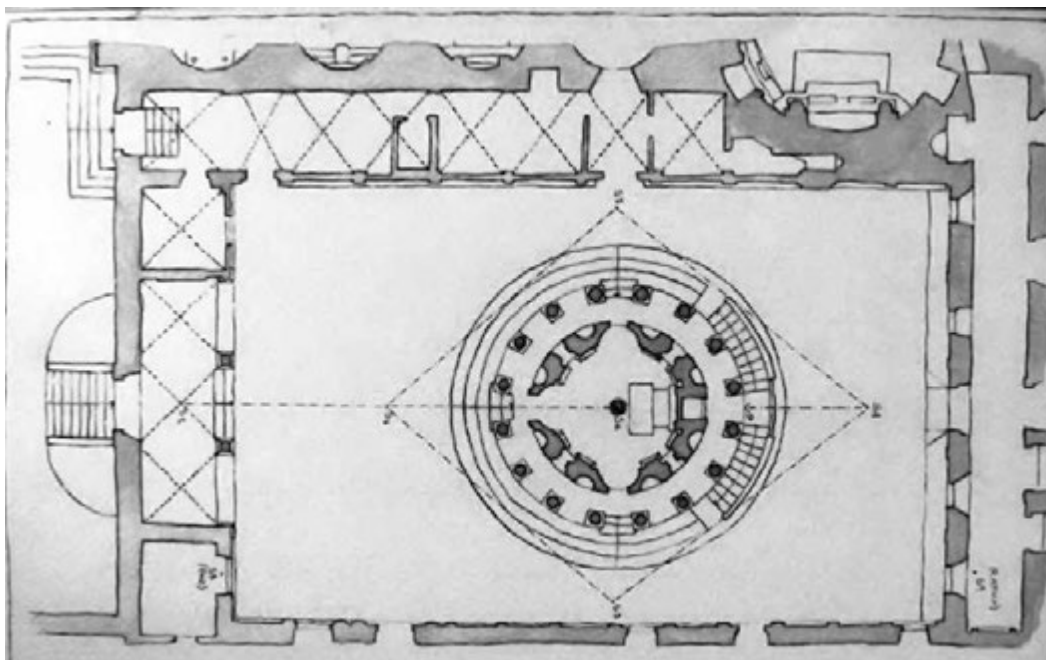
Tempio di San Pietro in Montorio, eidotipo della pianta con indicazione della poligonale
